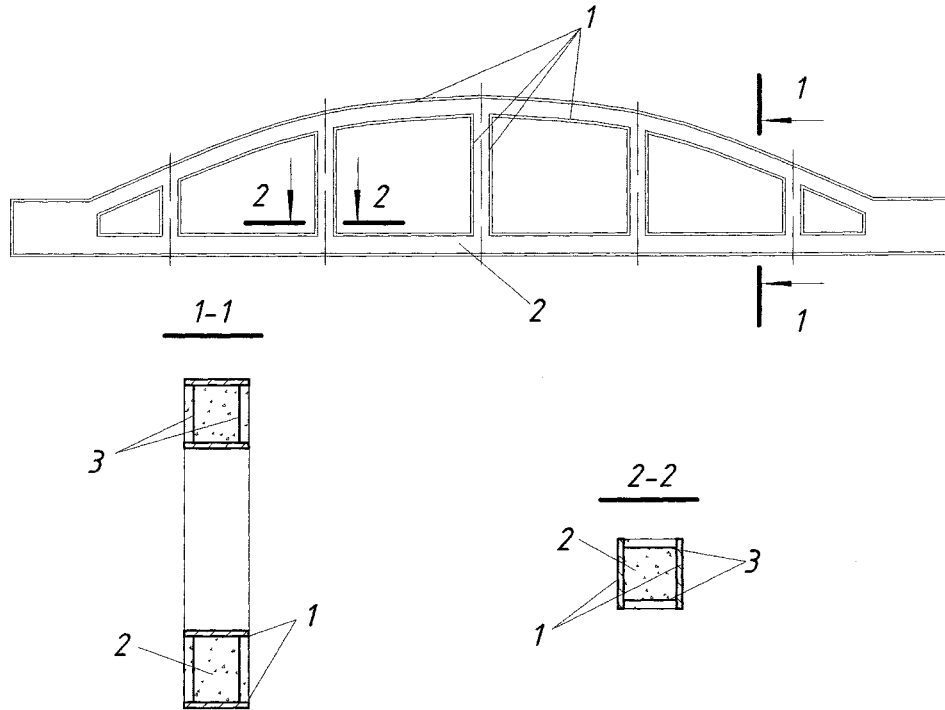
Безрозкісна аркова ферма із зовнішнім листовим армуванням
